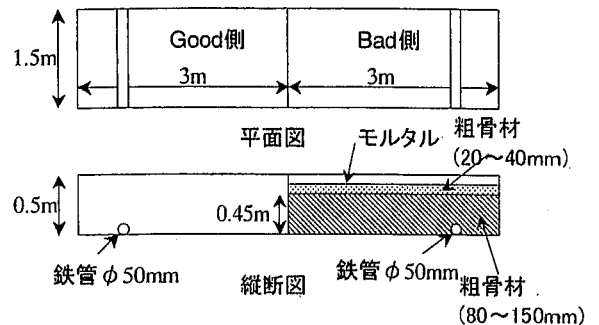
疑似施工不良部試験モデルの平面図・縦断面図
